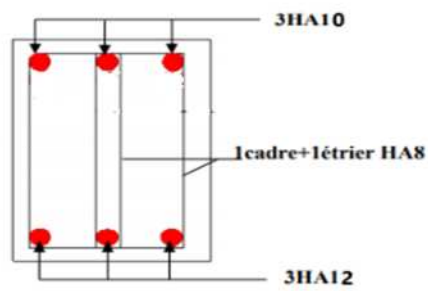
Schéma de ferrailage de la poutre de chaînage.
